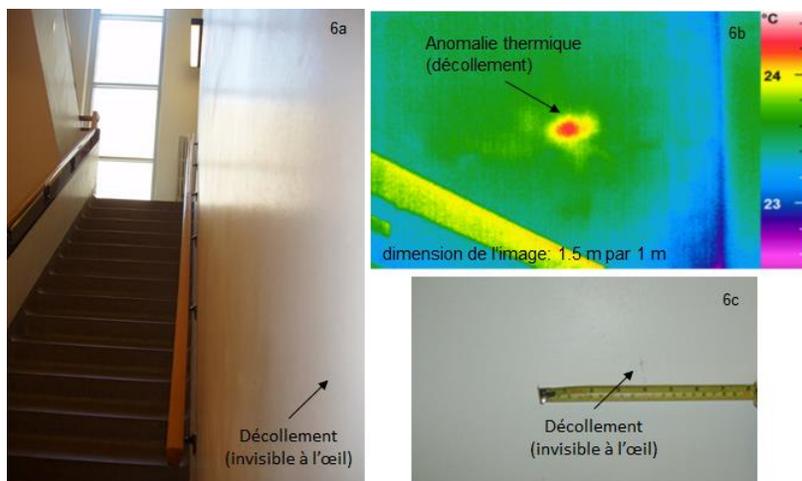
Détection d'un décollement sur un mur ensoleillé
